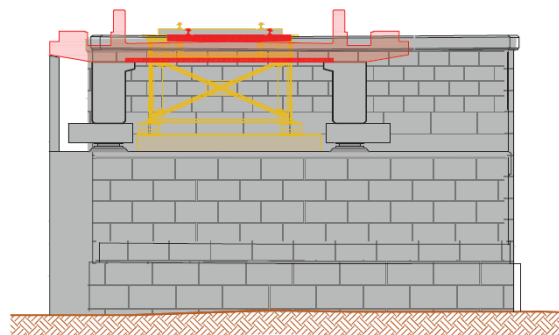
Execução do tabuleiro ponte do Caiola [42]
